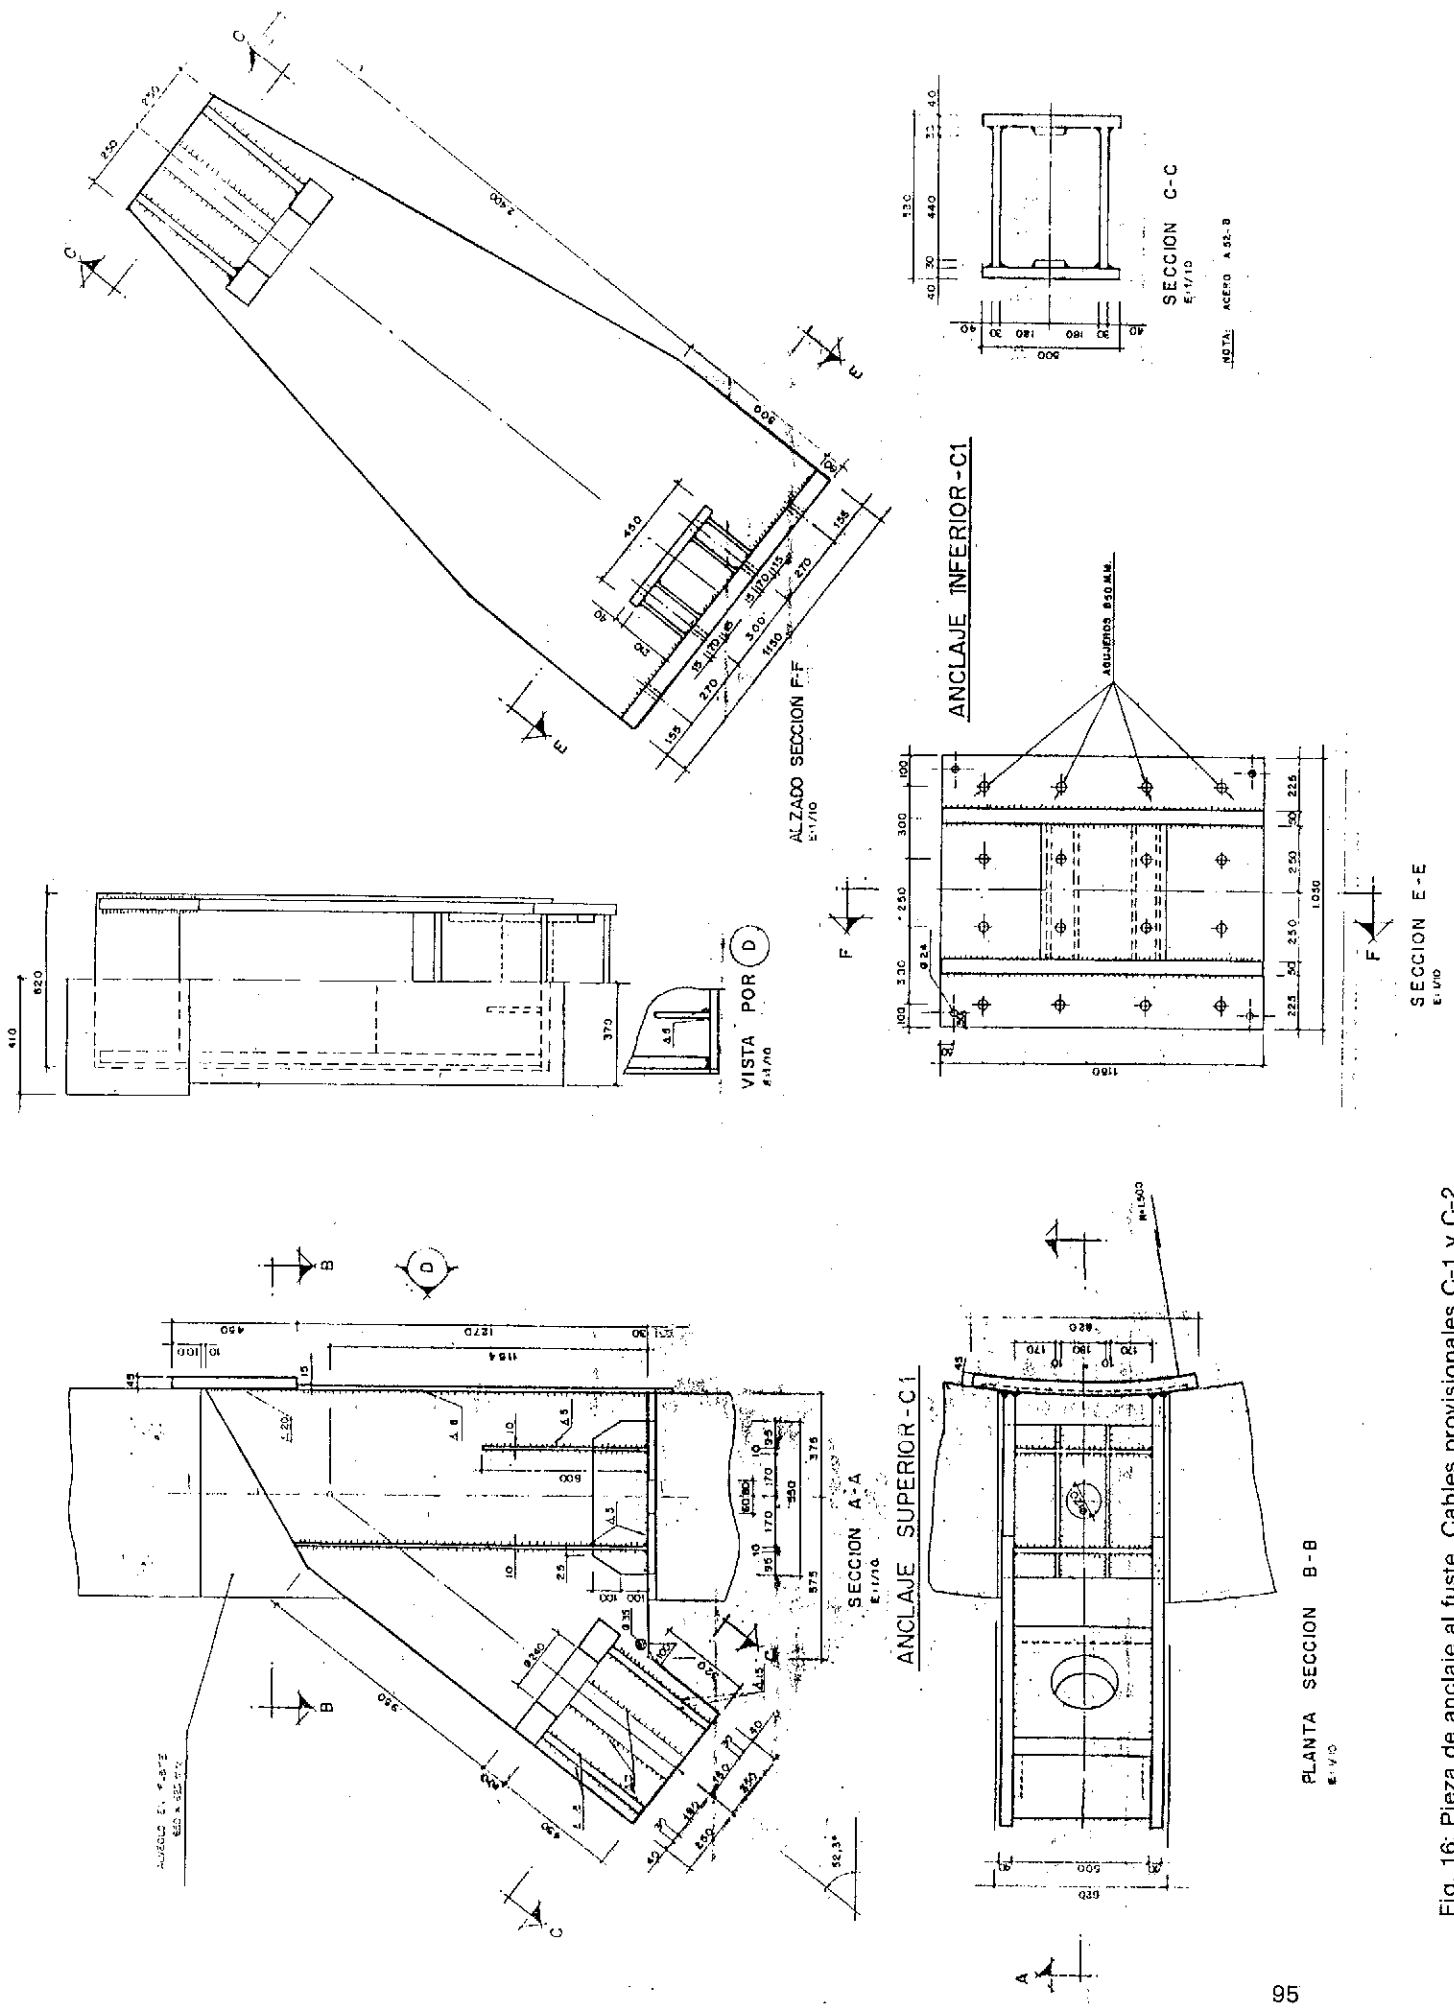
Pieza de anclaje al fuste. Cables provisionales C-1 y C-2.
